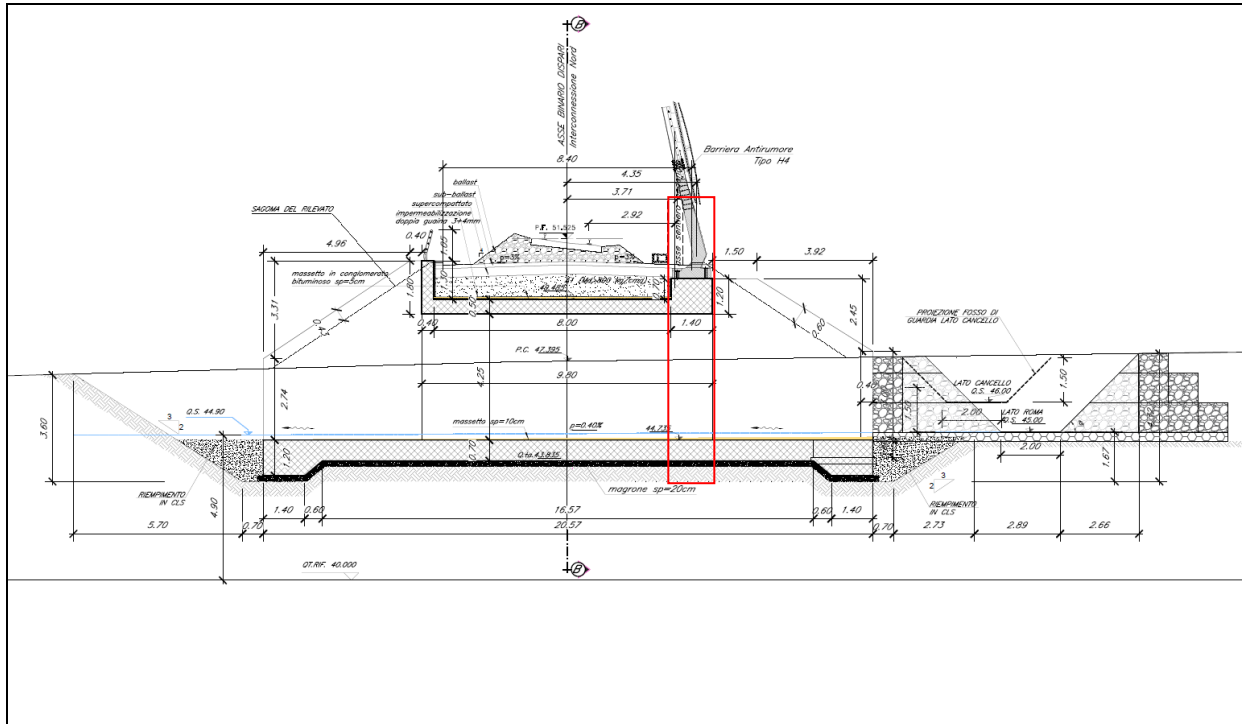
Sezione longitudinale e individuazione delle sezioni SC2 oggetto di verifica.
